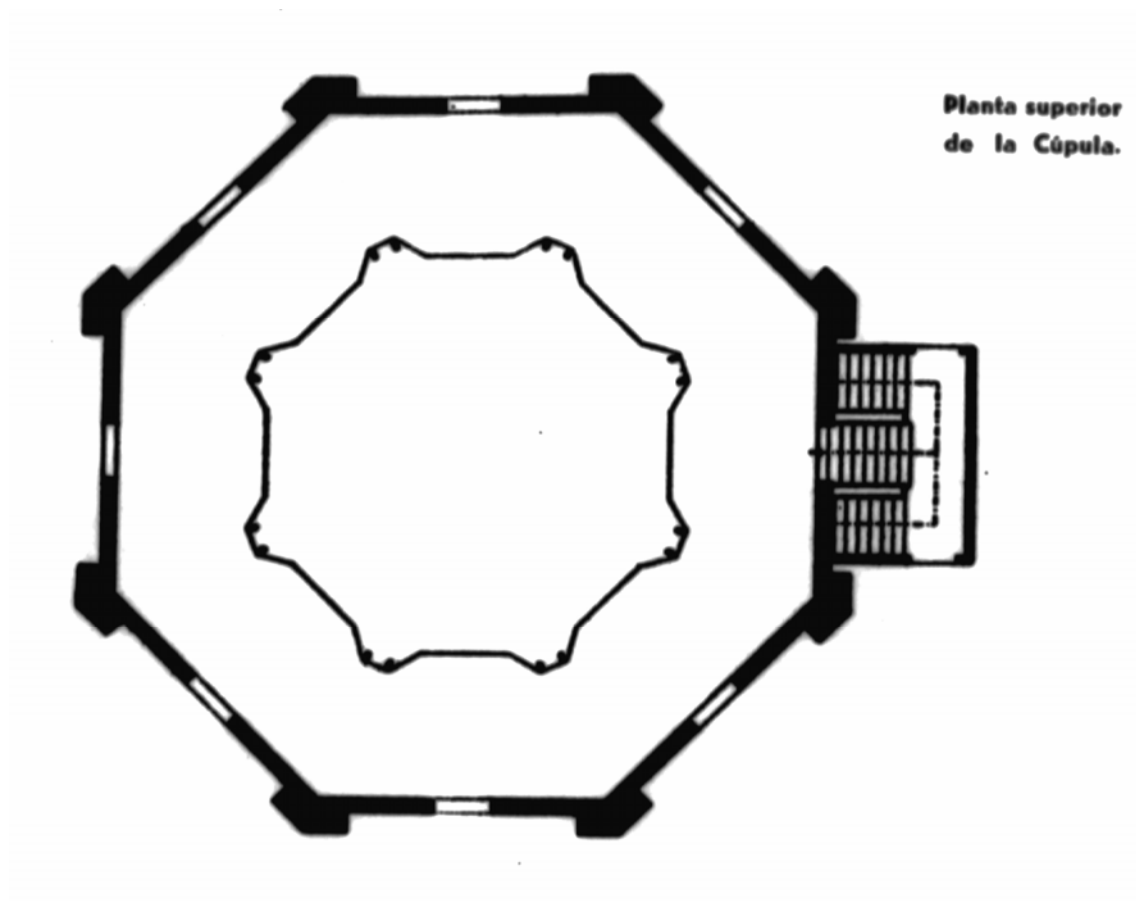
Planta del pis superior de la Cúpula, amb l'escala d'accés i les vuit balconades.
